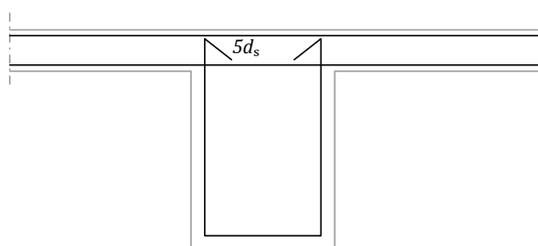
Biegeform oben offener Bügel und Gurtbewehrung
